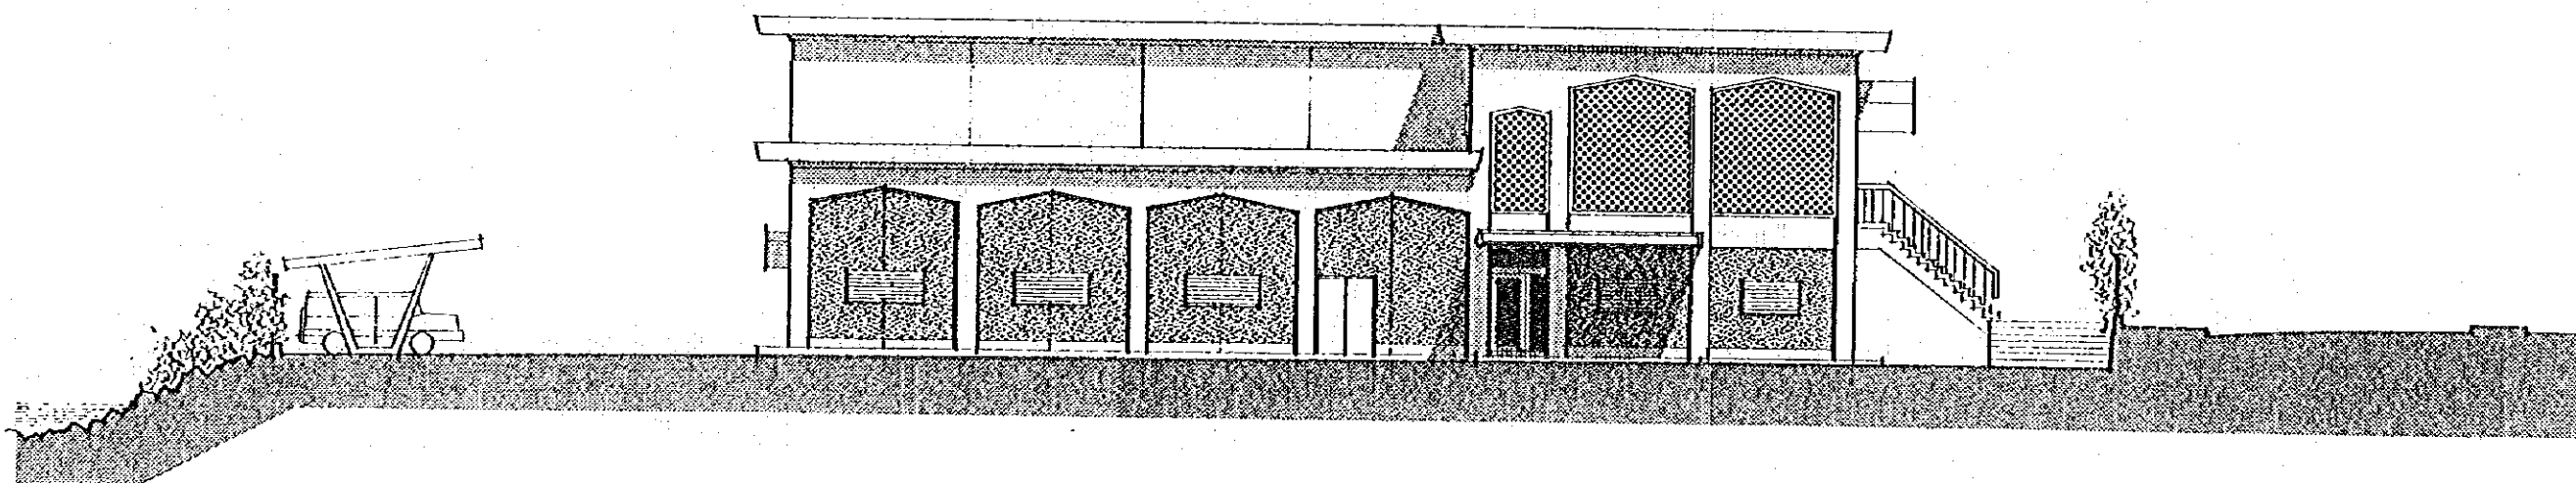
PLAN DU CENTRE DE LA TELEVISION (PROFIL-1)
